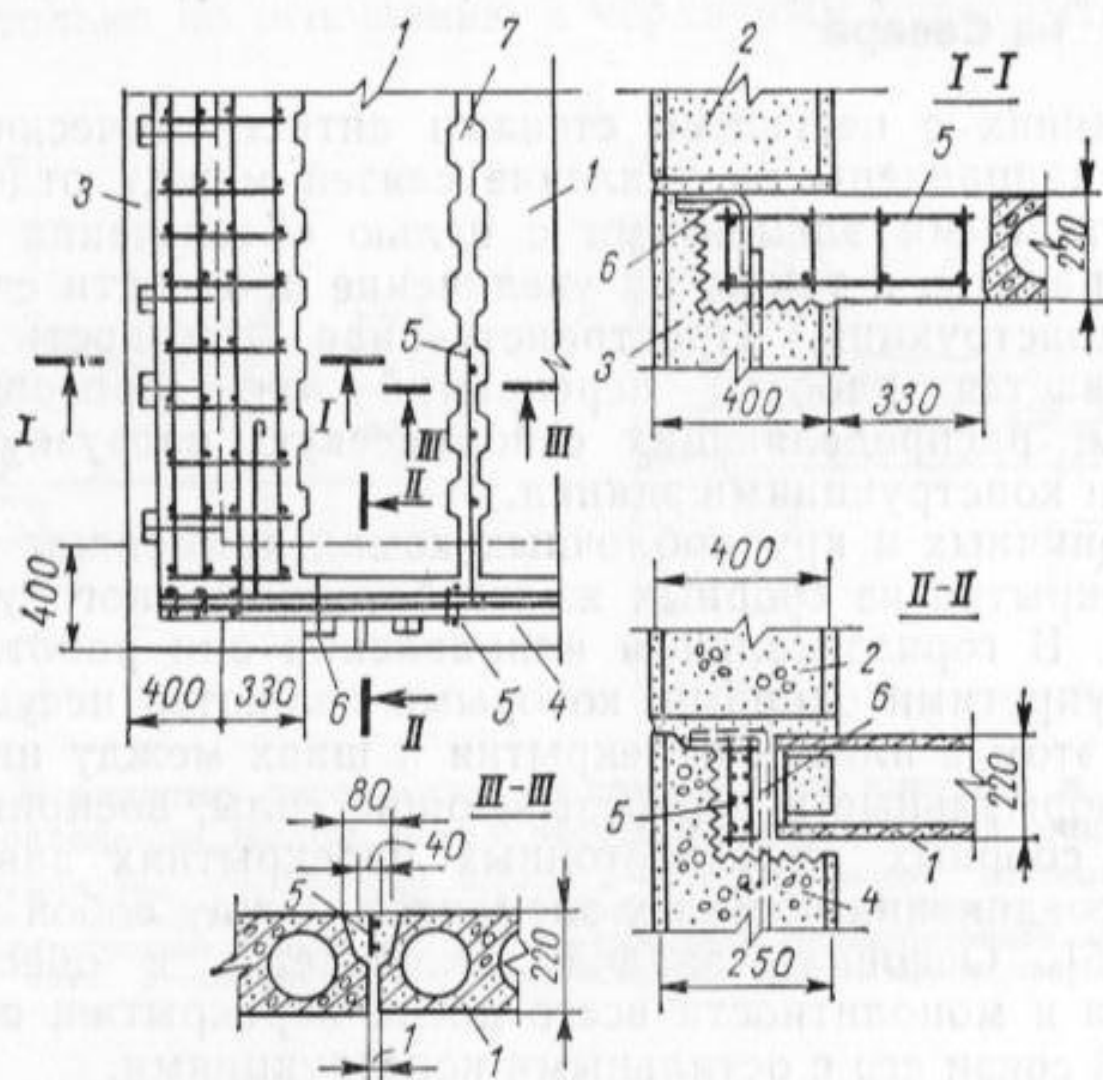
Устройство антисейсмического пояса в уровне перекрытия у наружной стены в крупноблочном доме серии 123 в Магадане (сейсмичность 7 баллов)
